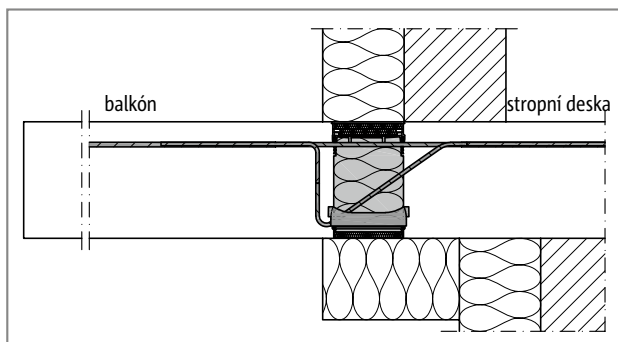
Schöck Isokorb® XT typ KL, QL-VV: Balkón ve vnitřním rohu, podepřený ze dvou stran
